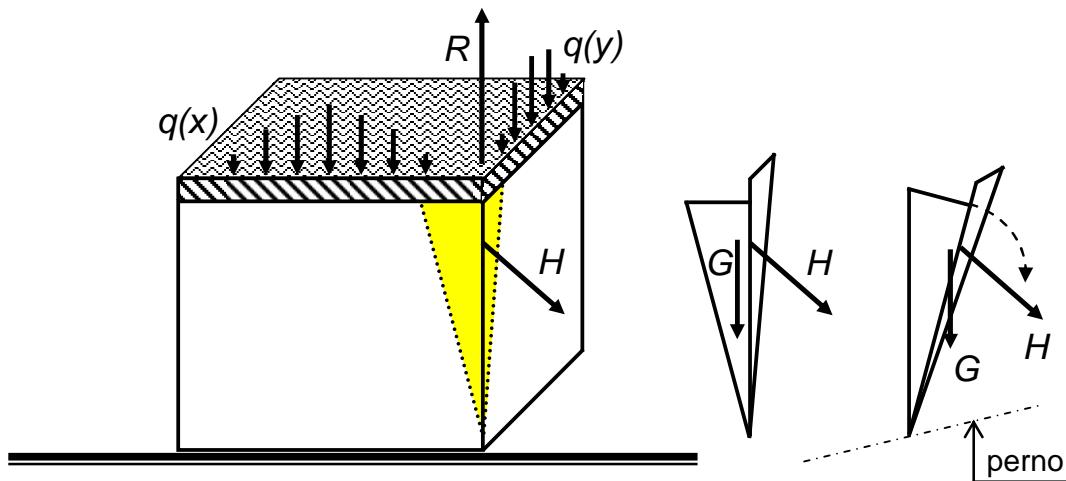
f. L'edificio è assoggettato a un'azione sismica. Tale sisma si manifesta con due componenti concomitanti: (1) una verticale, (2) e una orizzontale diretta diagonalmente ai due paramenti murari. La componente sismica verticale verso il basso determina la reazione q verso il basso lungo le sommità x e y dei muri, e la reazione R agli spigoli verso l'alto. La componente sismica orizzontale tende a fare ruotare il cantone fuori dal volume dell'edificio. Sia H la forza statica equivalente all'azione sismica orizzontale agente sul cantone. Tale forza H induce dunque il ribaltamento del cantone, facendo perno su un asse obliquo rispetto a ciascuno dei muri ortogonali.
